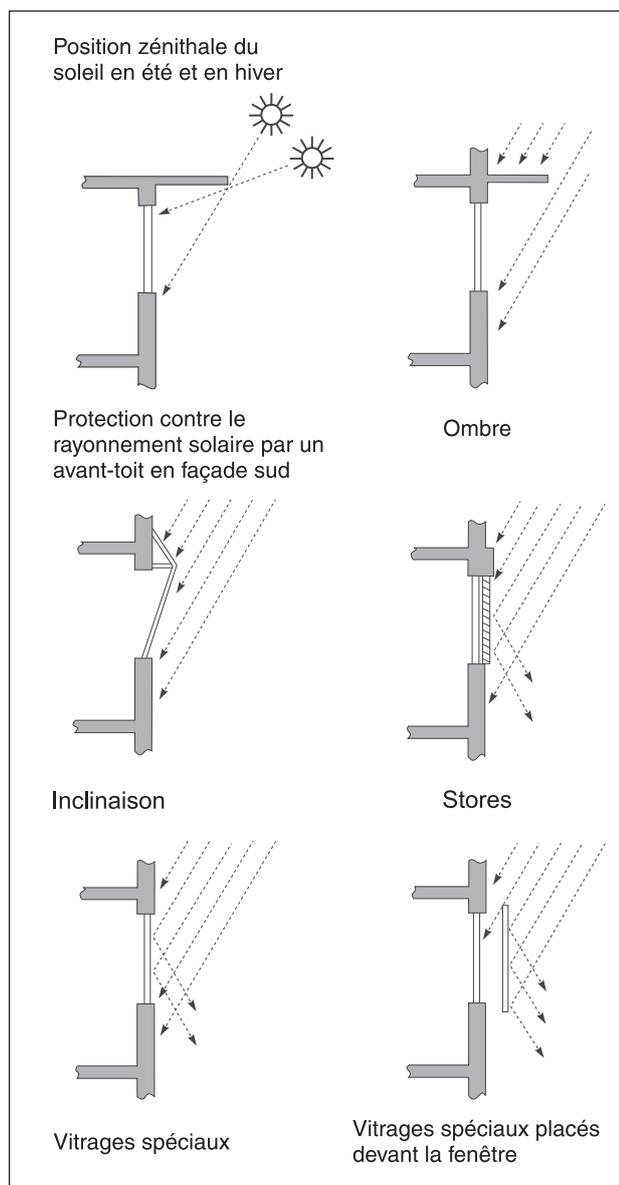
Exemples d'éléments pare-soleil en façade
